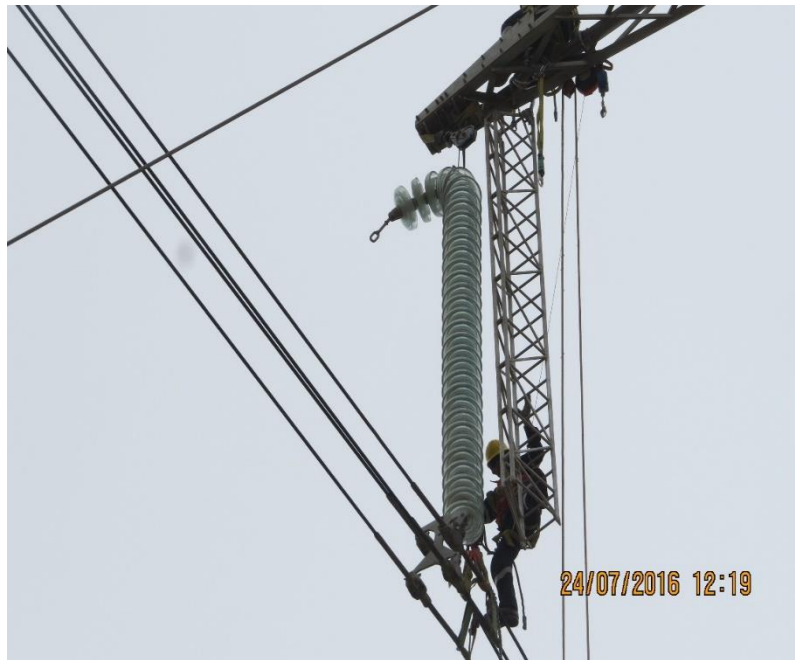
Lavado de aisladores en torre de anclaje.
